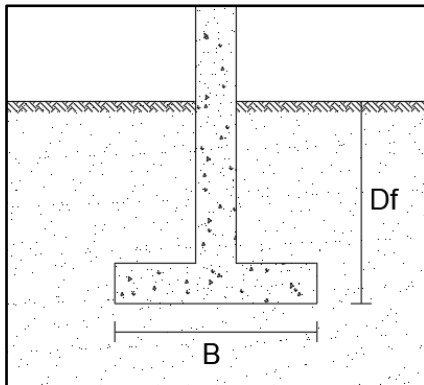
Corte transversal de una zapata. Fuente: Propia
